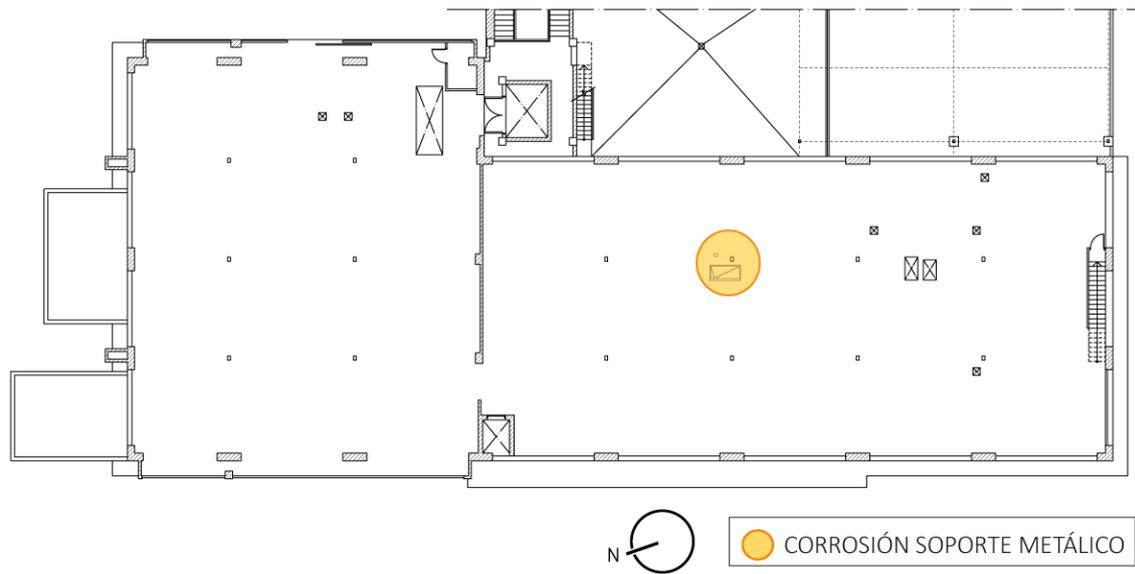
Localización soporte metálico afectado por corrosión (plano de tercera planta, nave I). Fuente: elaboración propia.
